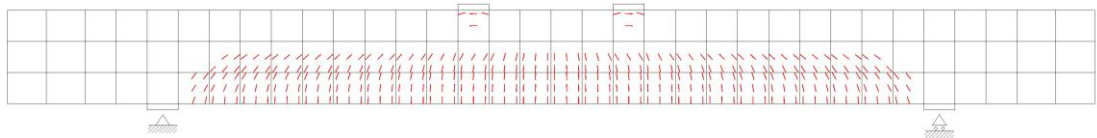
破壊時の変形及びひび割れ状態 (Case No. 3)
